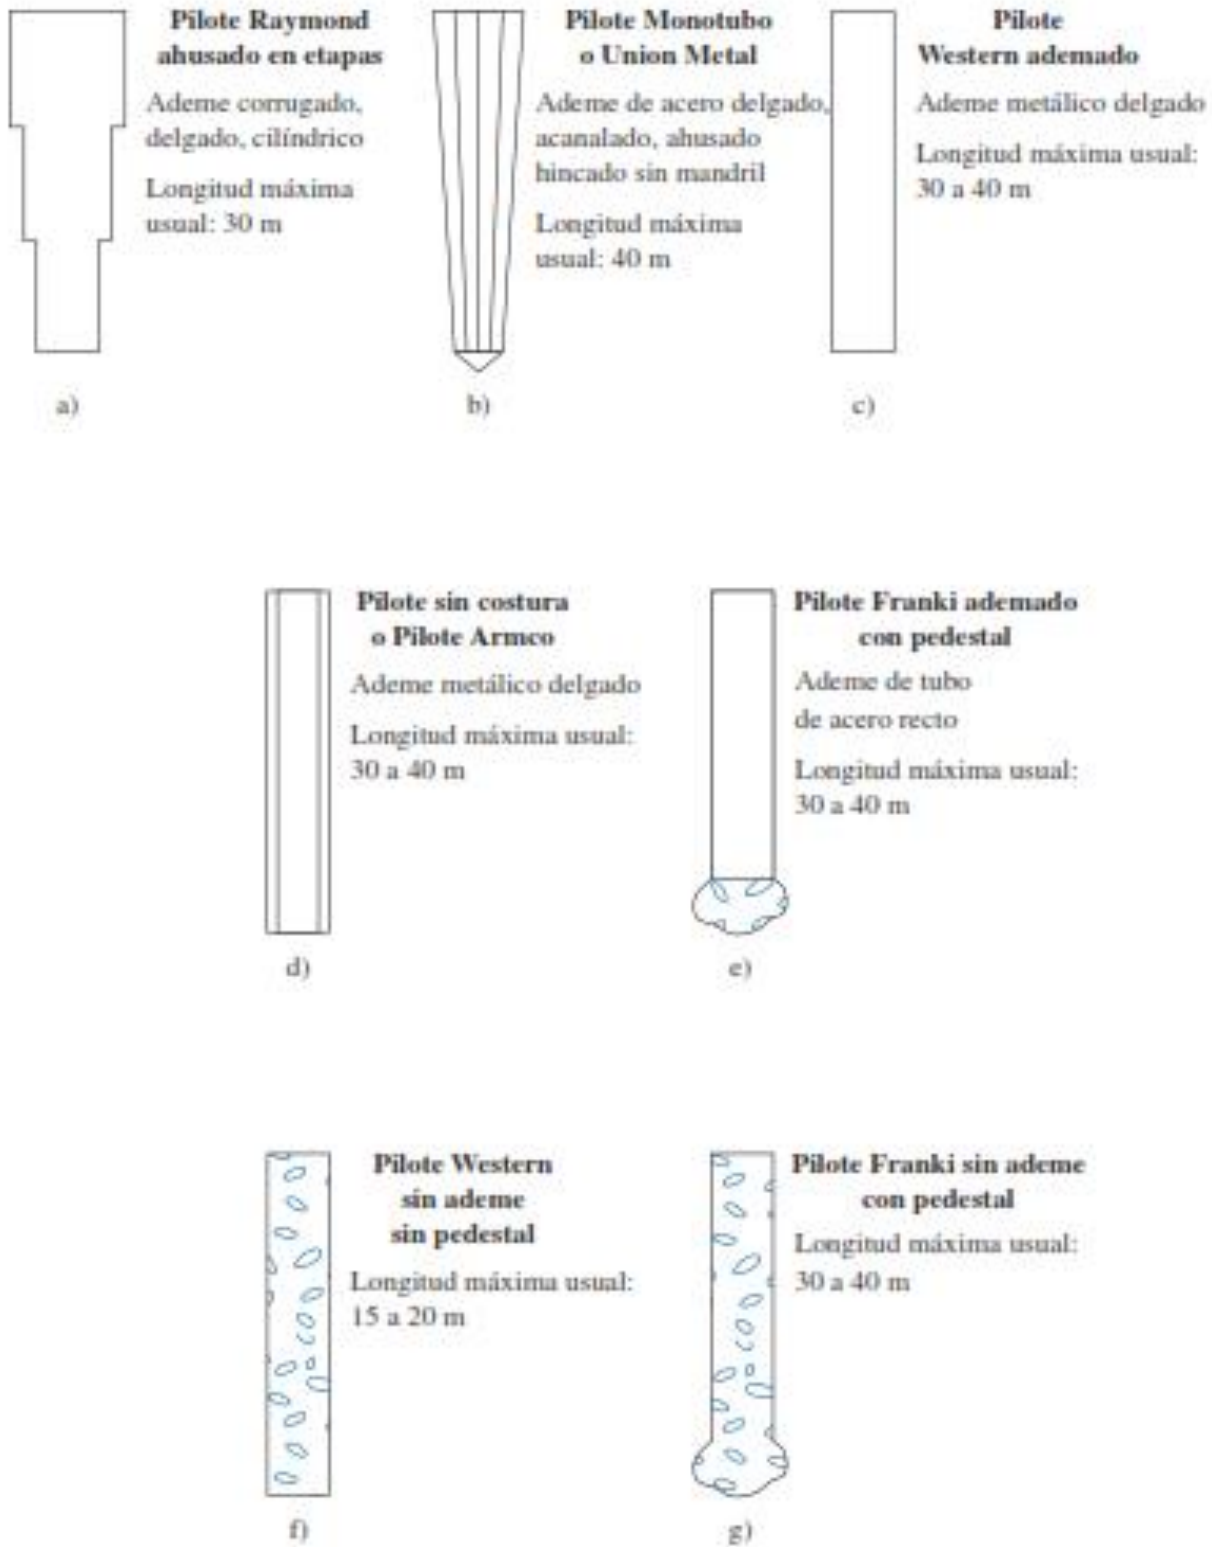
Pilotes de concreto vaciados en sitio, Adaptado de “Fundamento de ingeniería de cimentaciones”, por Braja M. Das (2012)
